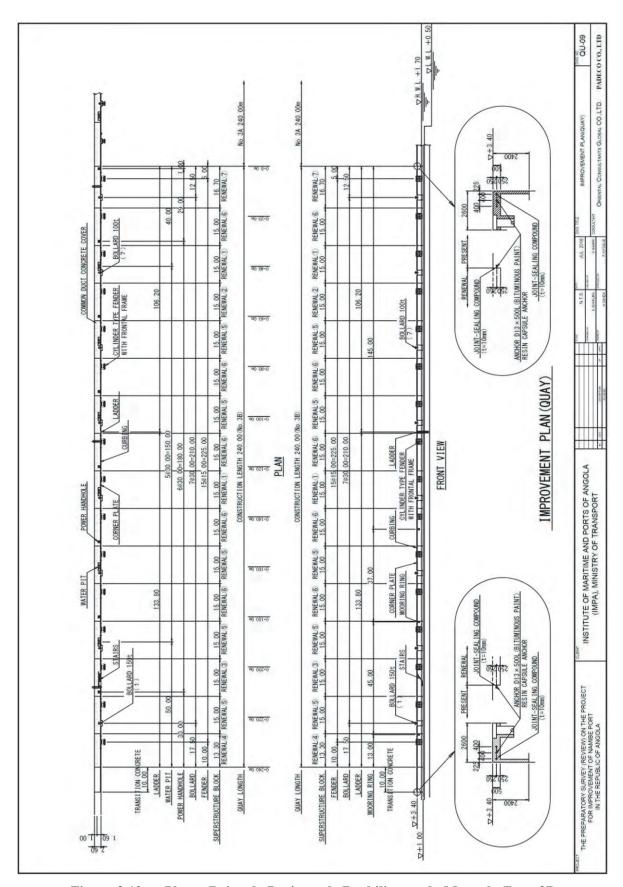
Planta Baixa do Projecto de Reabilitação do Muro da Zona 3B
